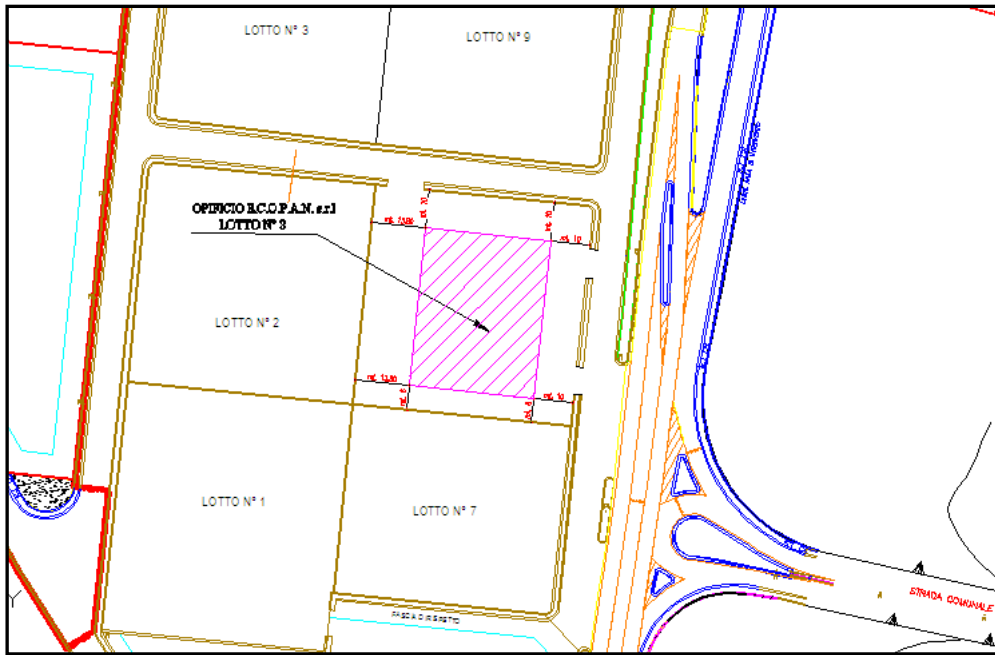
Stralcio Planimetrico dell'area P.I.P.
